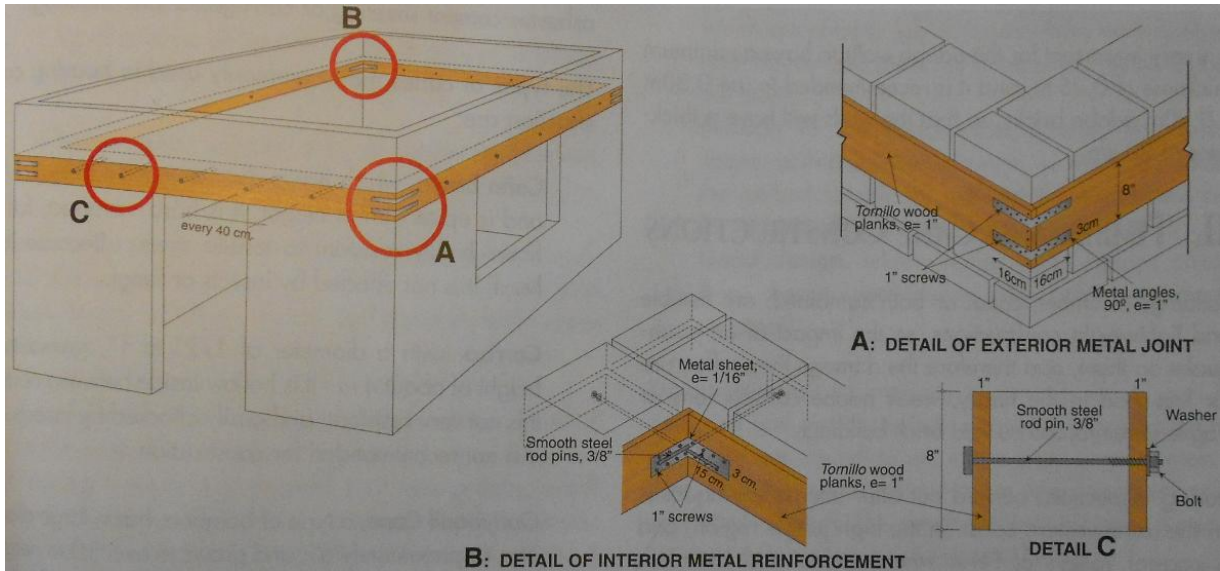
Viga collar de madera externa (Kuroiwa, 2004)
